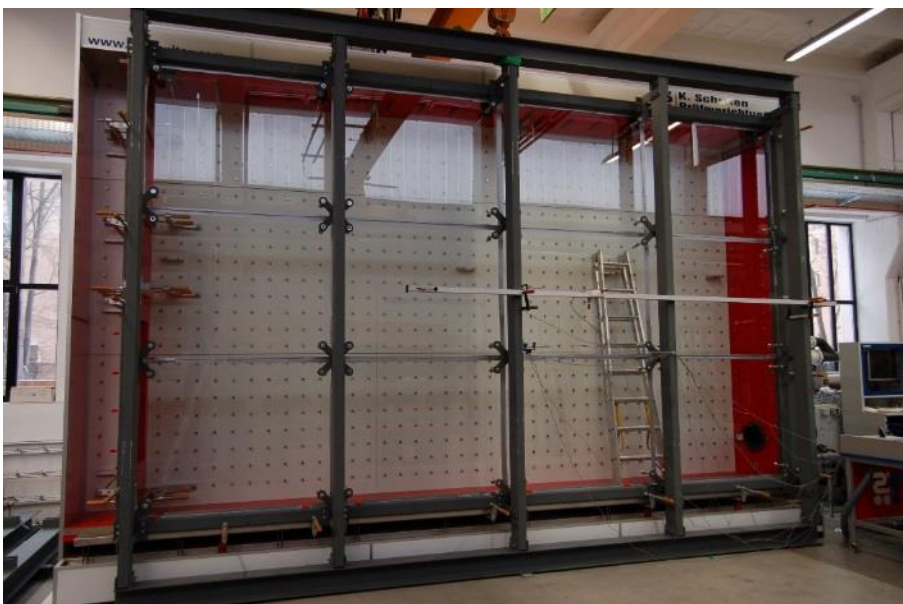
Versuchsaufbau zur Prüfung eines Fassadenausschnitts durch Beaufschlagung mit Winddruck- sowie Windsoglasten.
